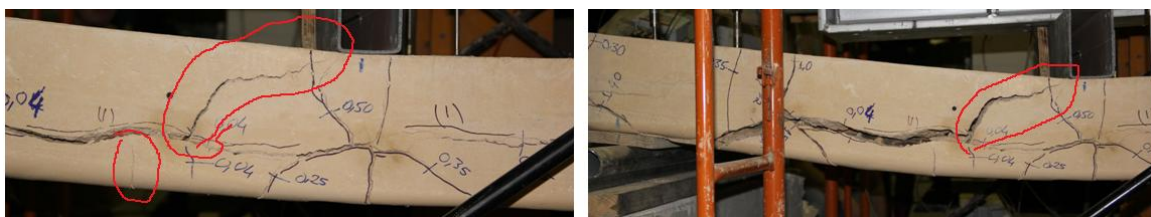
Laje L2: consolidação de fissuras existentes e surgimento de fissuras de esforço transverso.
